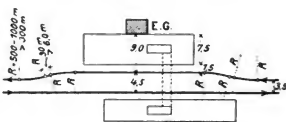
Haltepunkt mit schienenfrei zugänglich gemachten Außenbahnsteigen.
